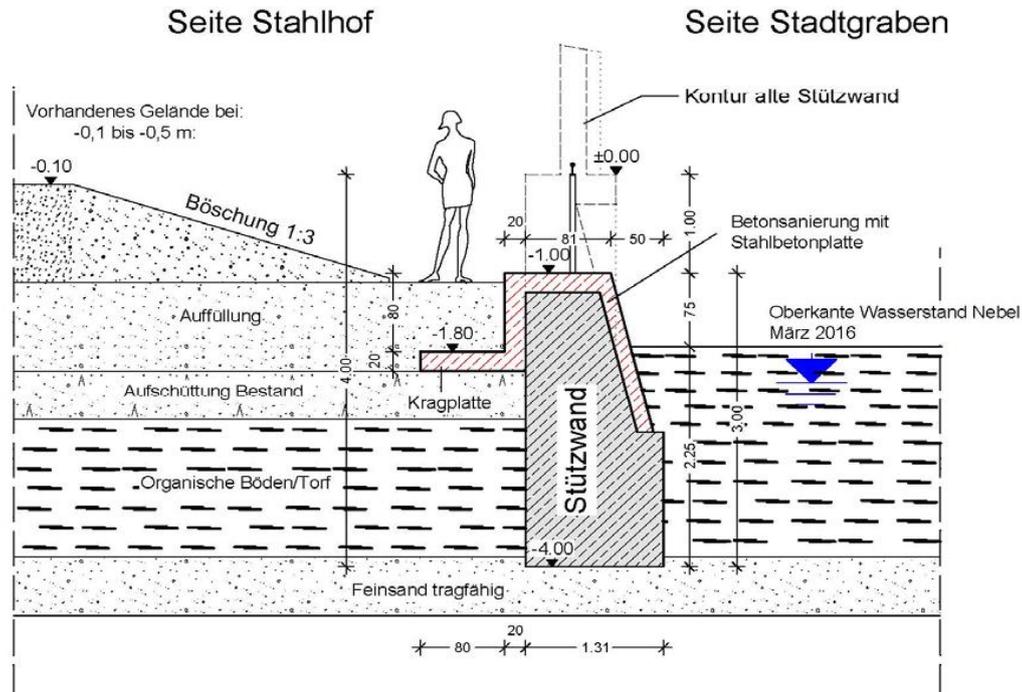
Sanierungsvorschlag aus statischem Gutachten Variante 1, Schnitt 1-1
